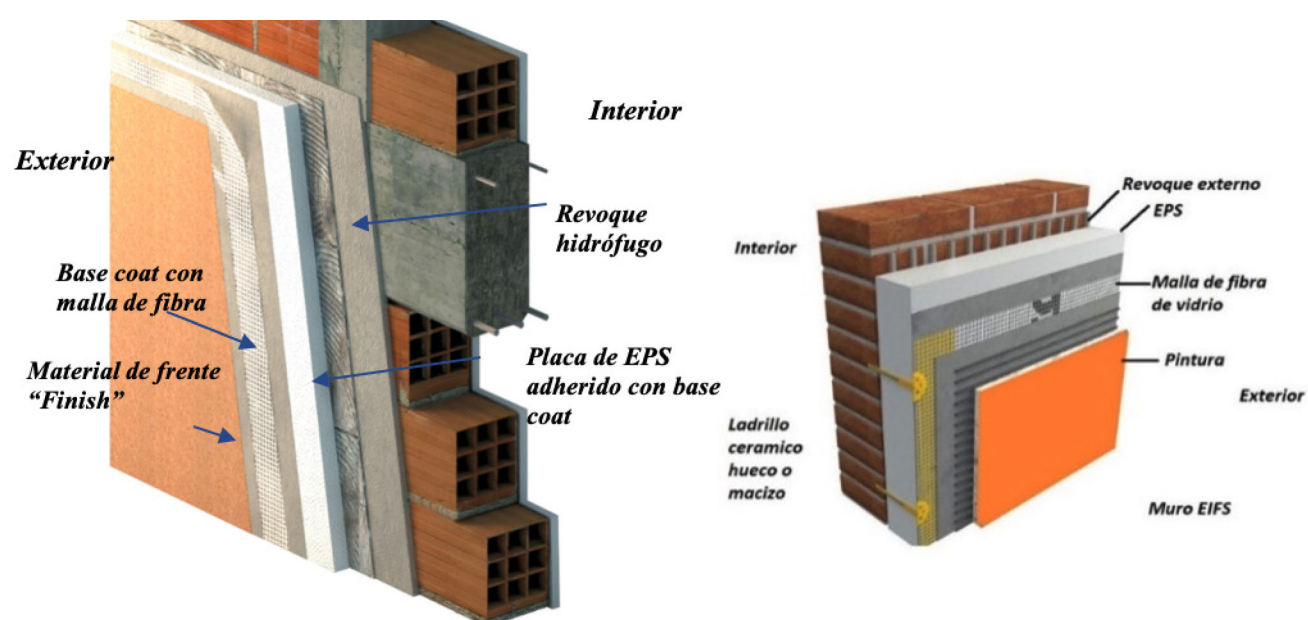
Ejemplos de muros con sistema de aislamiento y terminación exterior (EIFS), a la izquierda con ladrillos huecos y a la derecha con ladrillos macizos. Fuente: elaboración propia.
